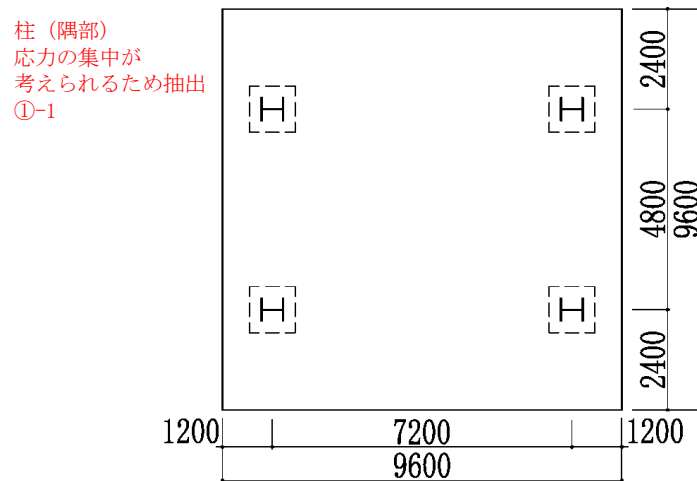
非常用ガス処理系配管支持架構の概略平面図 (EL. 7.7 m)
